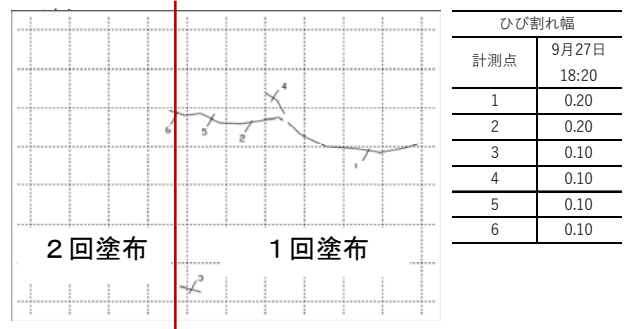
ひび割れ発生状況 (散水なし24時間)
